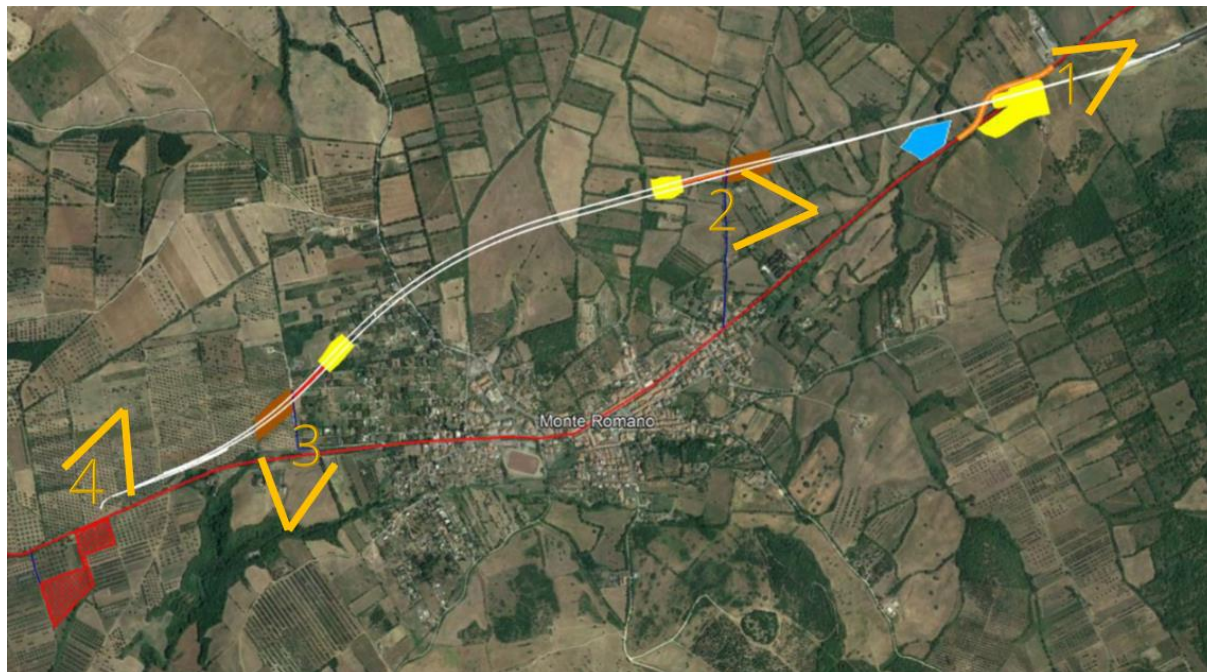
Figura – Keyplan delle aree di cantiere e del nuovo tracciato stradale della SS675
